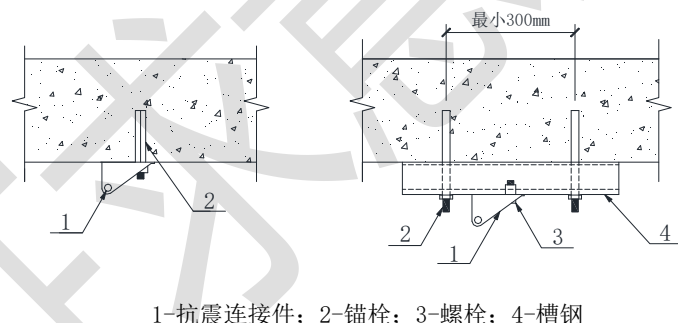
抗震连接件根部构造示意图（钢筋混凝土结构）
